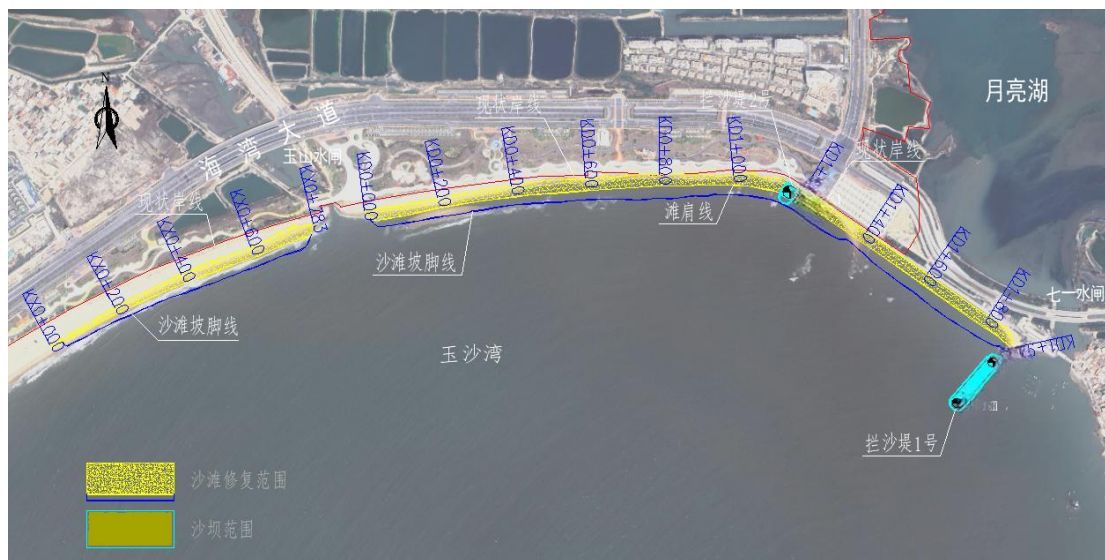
玉沙湾砂质岸线修复平面布置图（方案二）
